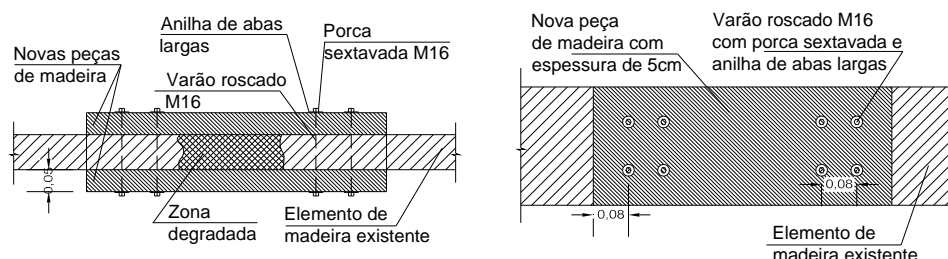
Reforço de elemento de madeira – planta e alçado.
